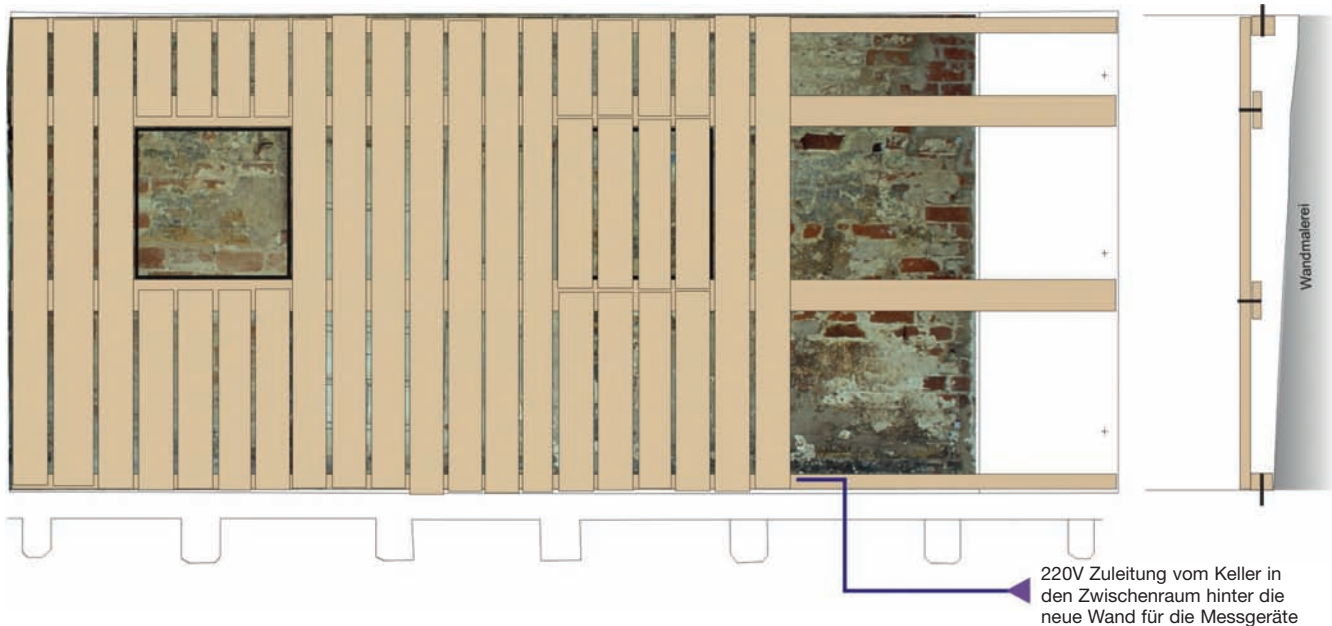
Lübeck, Fischergrube 84, Konstruktionszeichnung der Einhausung mit Zwischenwand und Klappe (nach Jaroslaw Kulicki).
